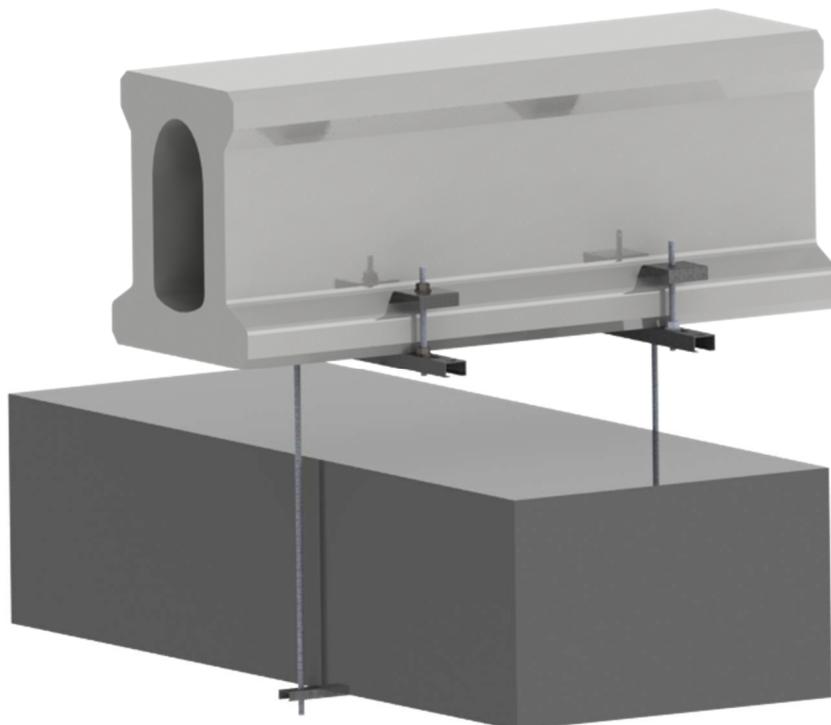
Conducto de aire acondicionado perpendicular a perfil instalado en sistema propuesto.
